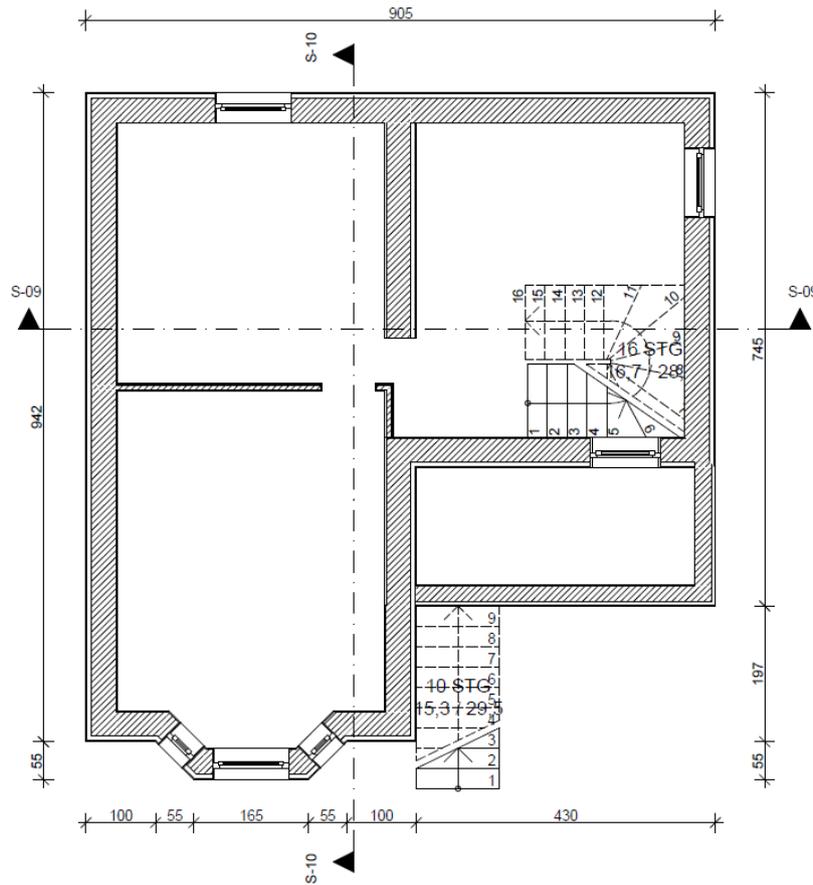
Fallbeispiel - Grundriss 1. Kellergeschoß, Software Archicad 26, (eigene Darstellung)
